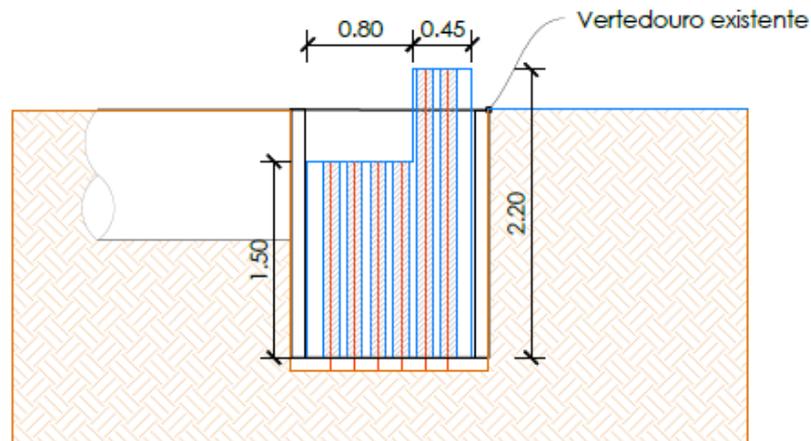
Modificações propostas na caixa do vertedouro – Vista em planta
